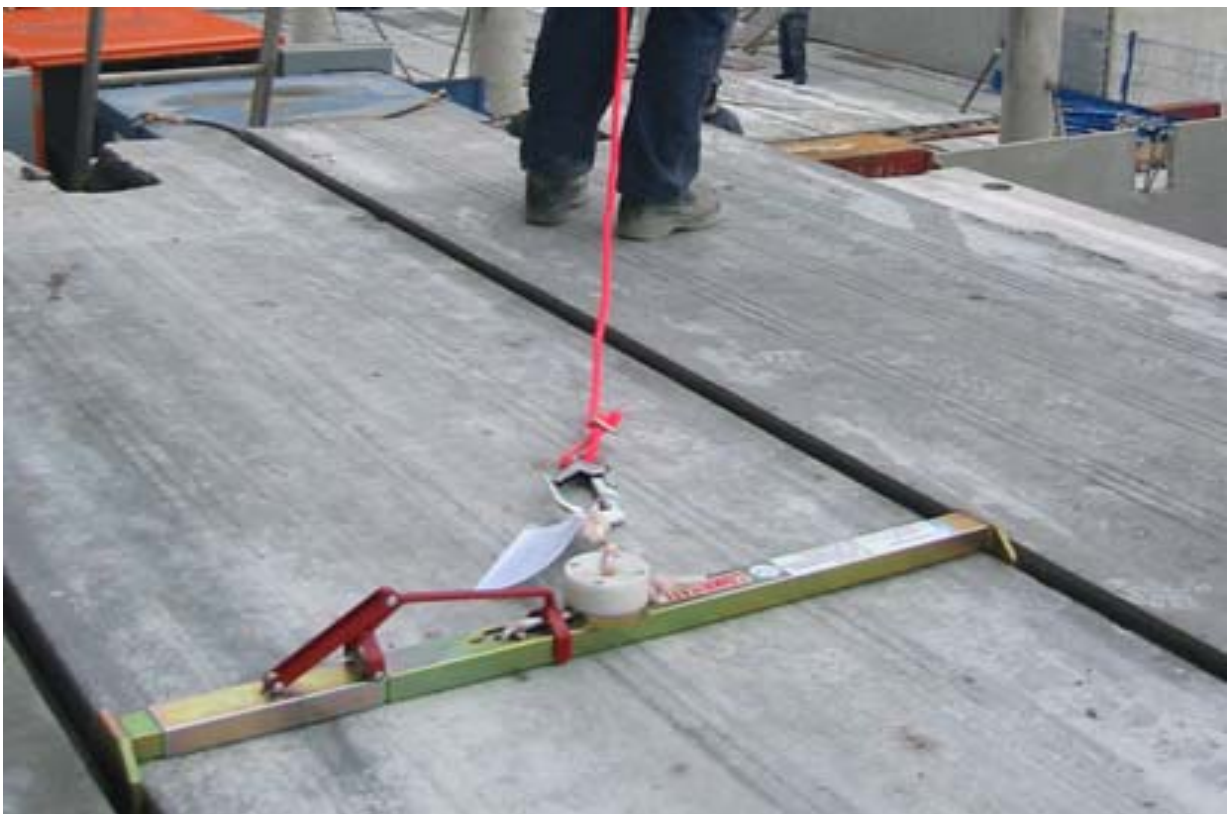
Realizzazione dell'ancoraggio sull'elemento strutturale del solaio⁵⁰
